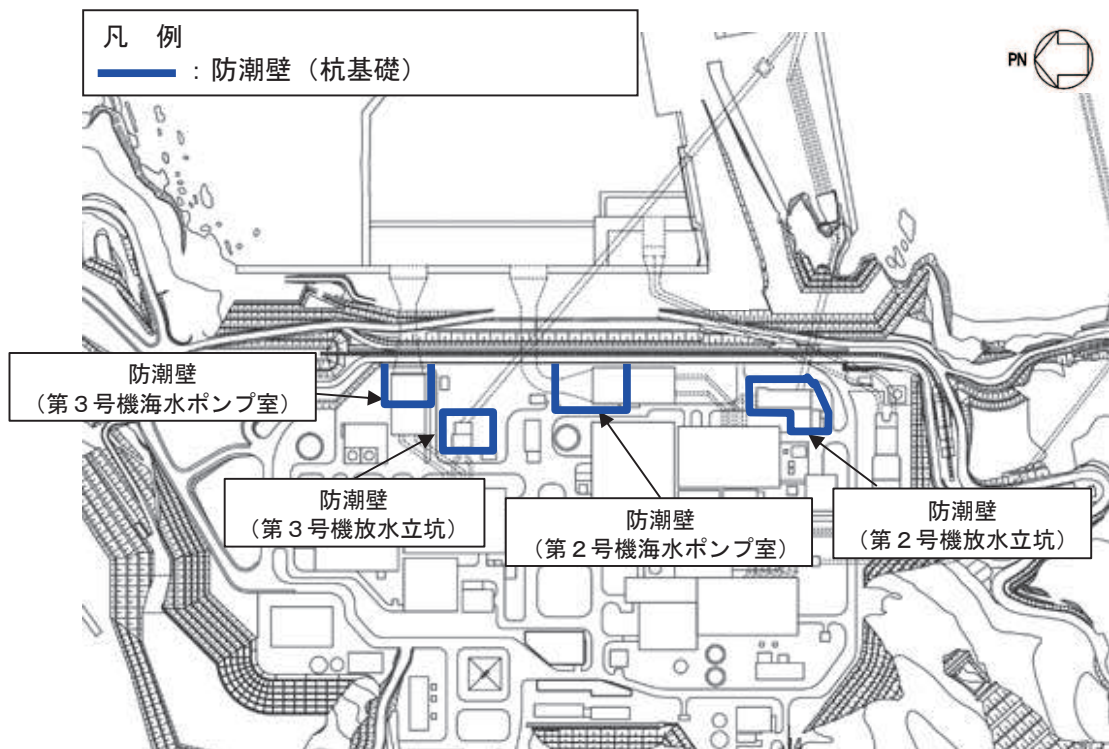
防潮壁（杭基礎）の平面配置図
